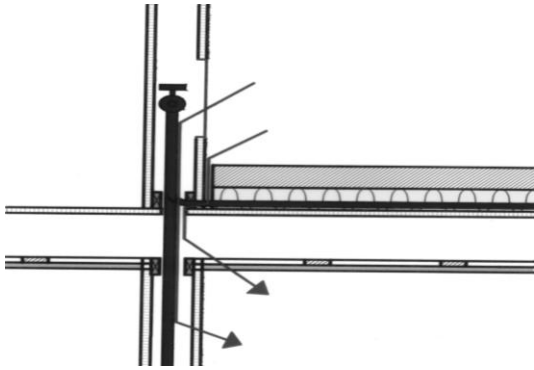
Heizkreisverteiler mit einfacher Blechtür über dem Installationsschacht.
